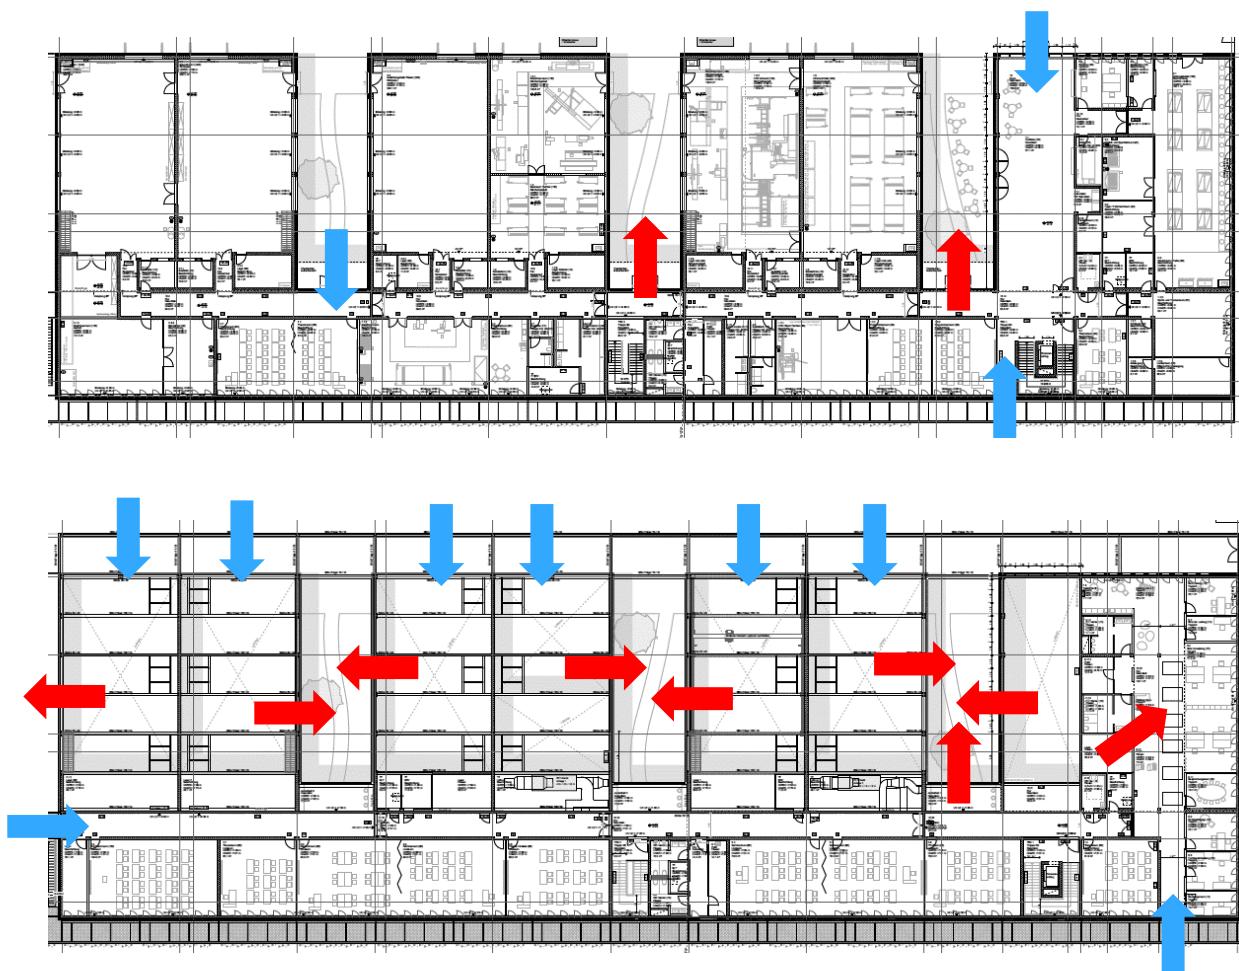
Nachtentwärmungskonzept über Verkehrsflächen, Hallen, Bürobereich und Foyer / Cafeteria: Grundriss EG (oben) und Grundriss OG (unten)
